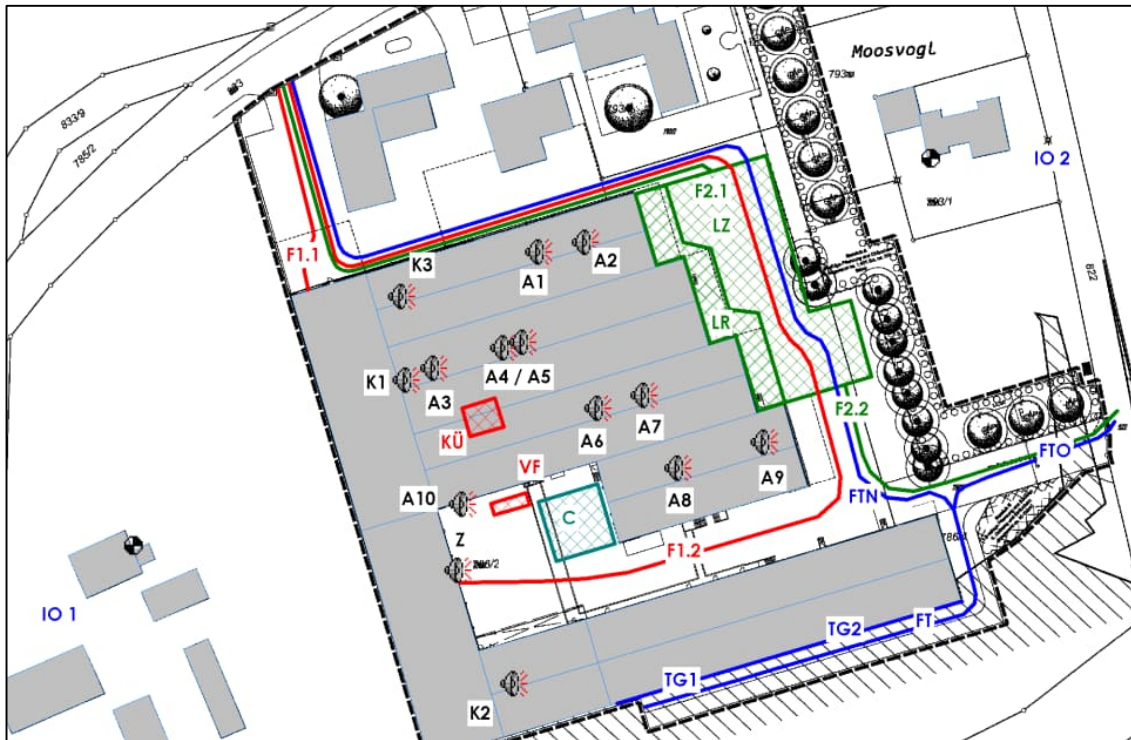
Lageplan mit Darstellung der relevanten Schallquellen
